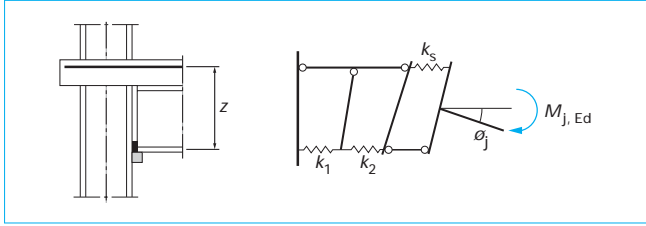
Modèle de ressorts pour l'assemblage à plaque de contact
